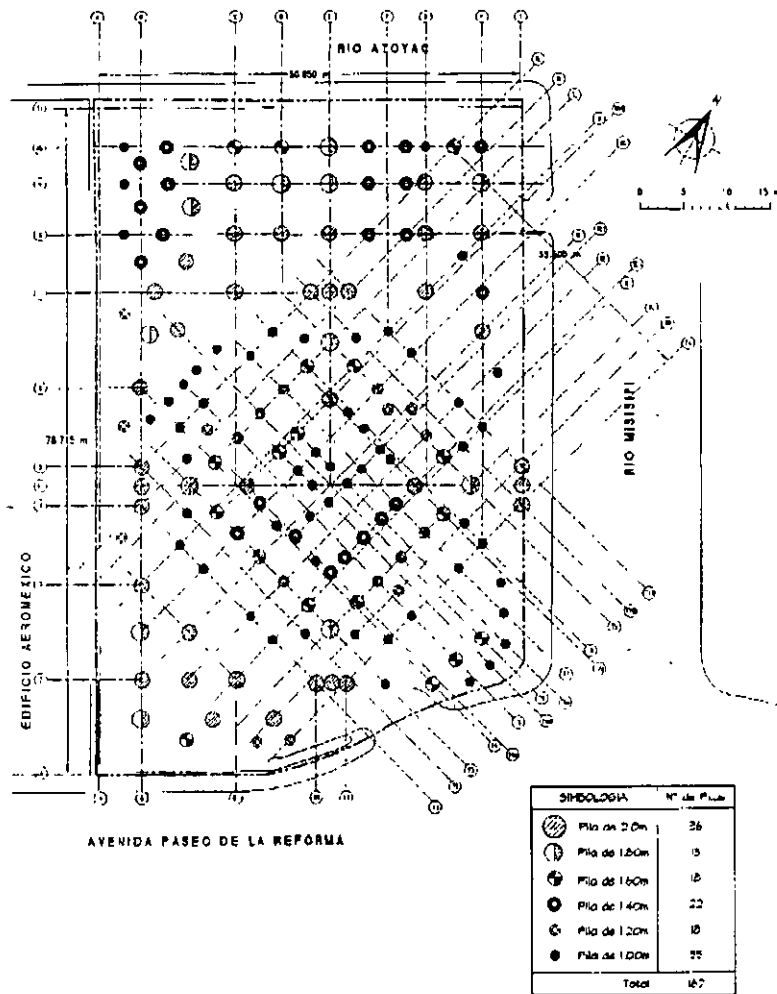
Distribución de pilas (Cortesía de Carlos E. Gutiérrez)
